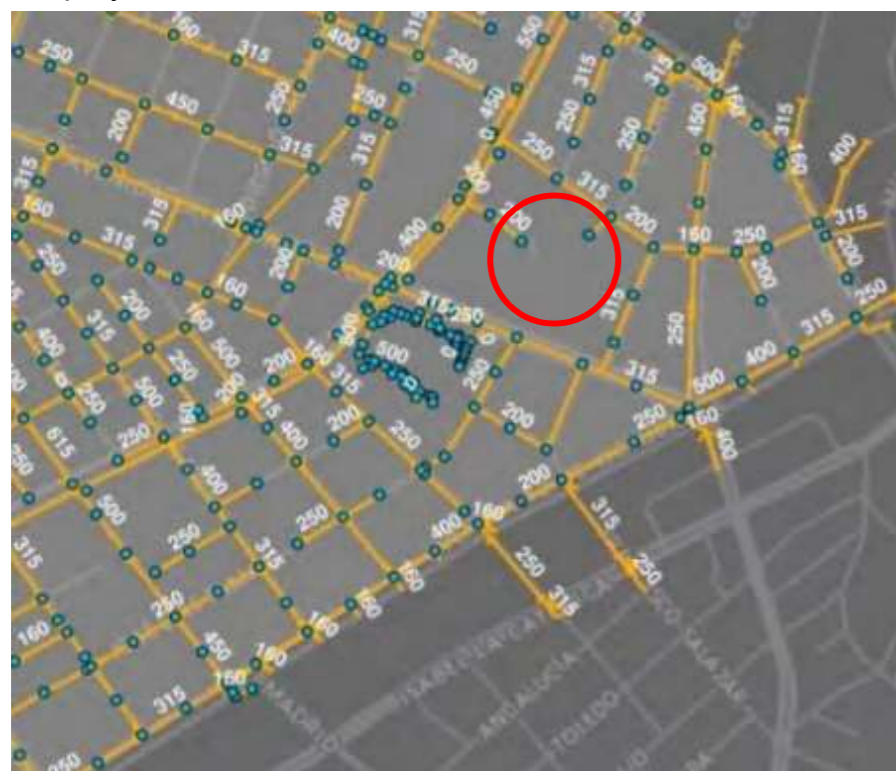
Plano de alcantarillado de la Mariscal Tomado de (Plan especial la Mariscal)
